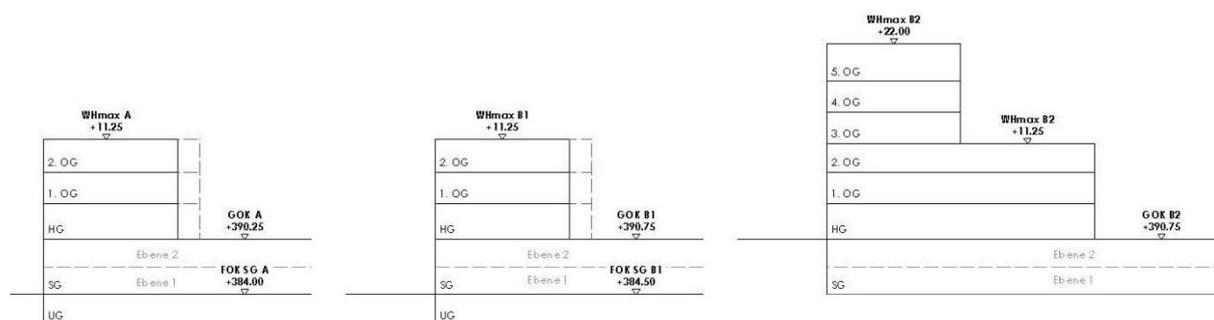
Systemschnitte zur Höhe der baulichen Anlagen
